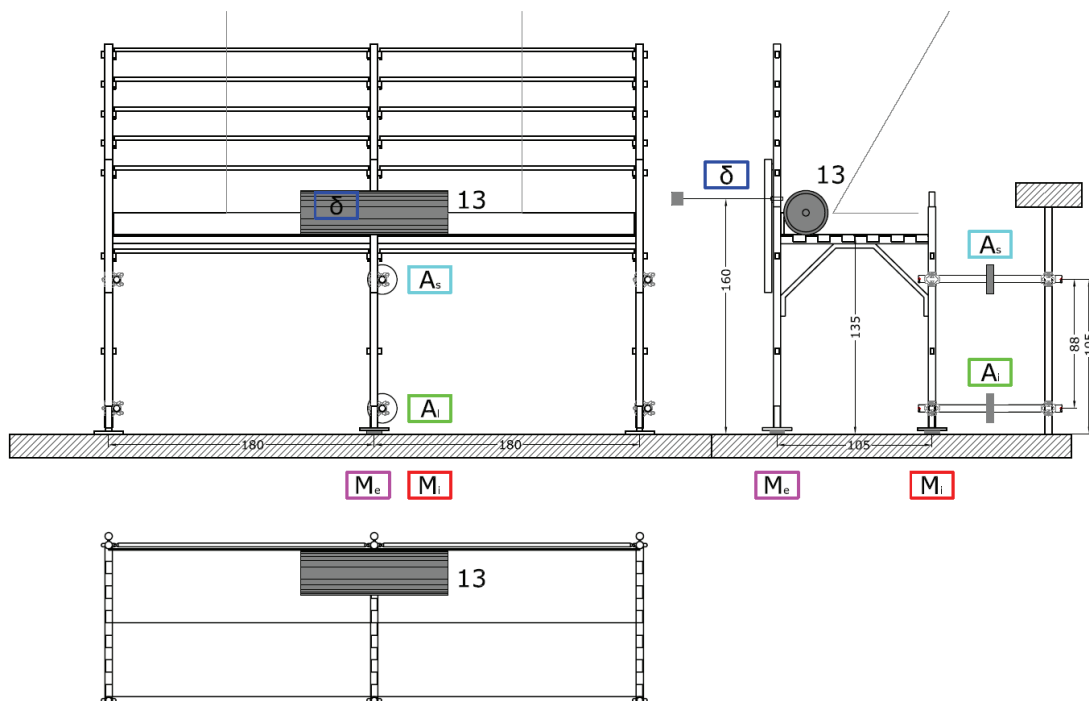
8 Prove d'impatto con rullo cilindrico su traverso – Schema CD – Posizione degli strumenti di misura
